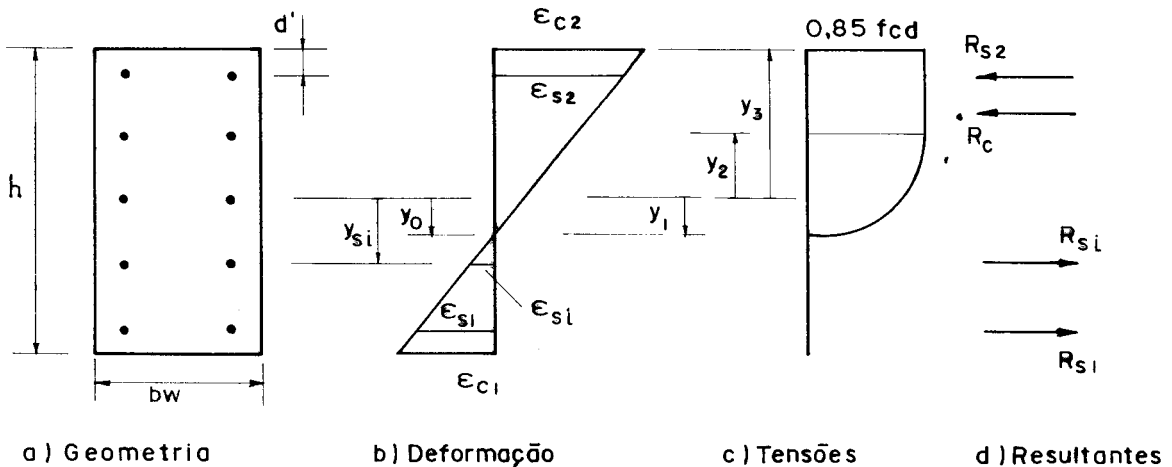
Seção retangular de concreto armado. Tensões e deformações.
